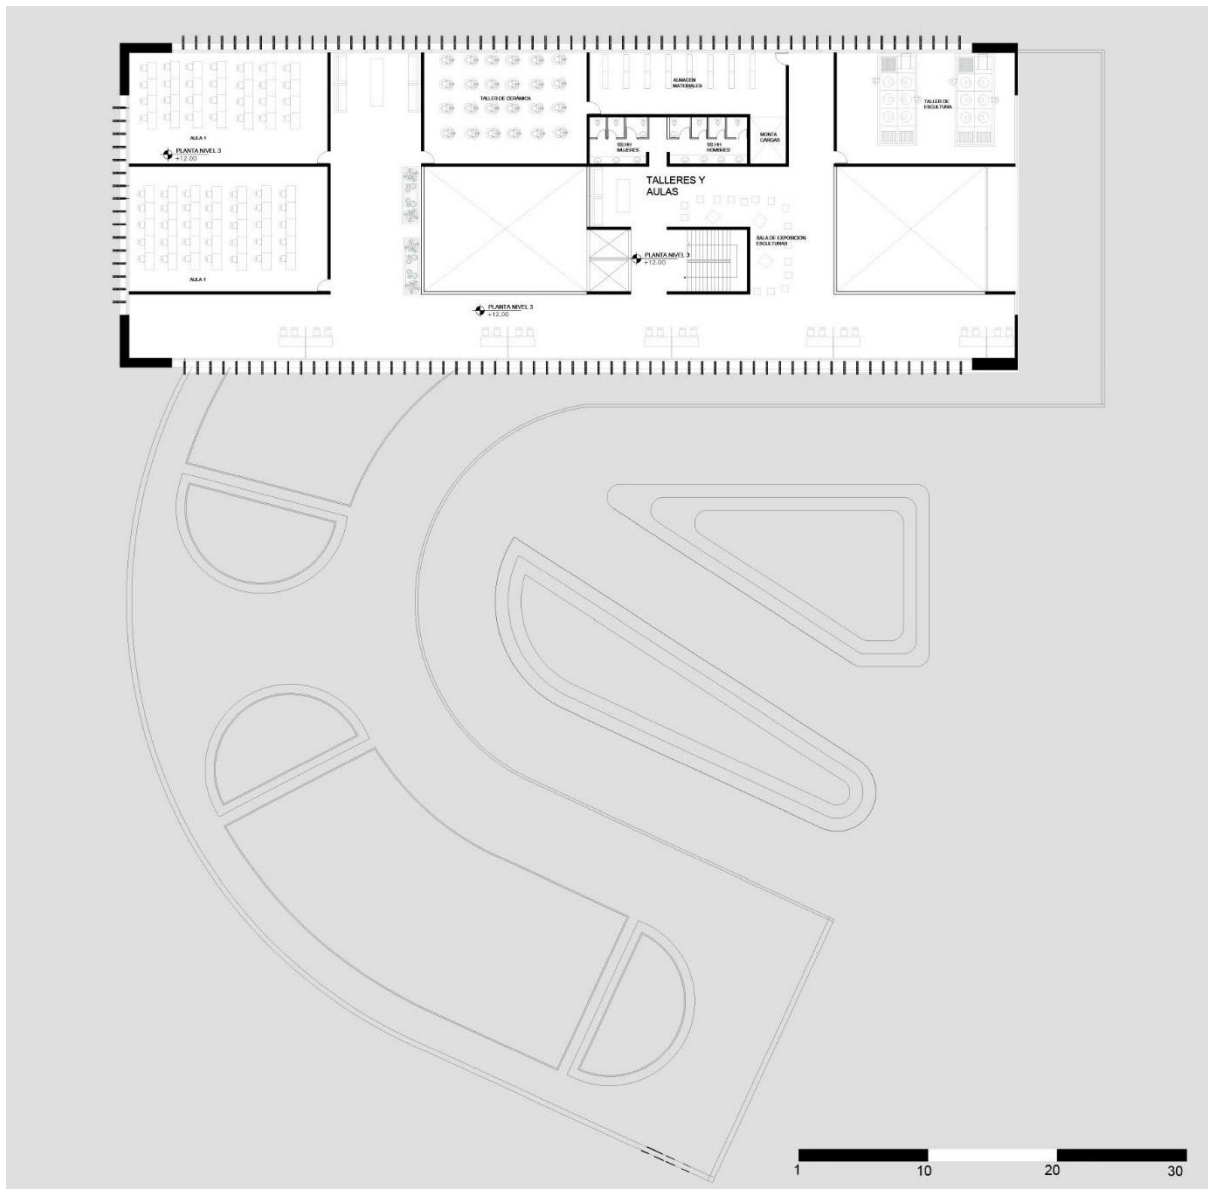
PLANTA NIVEL 3. Elaboración propia..
